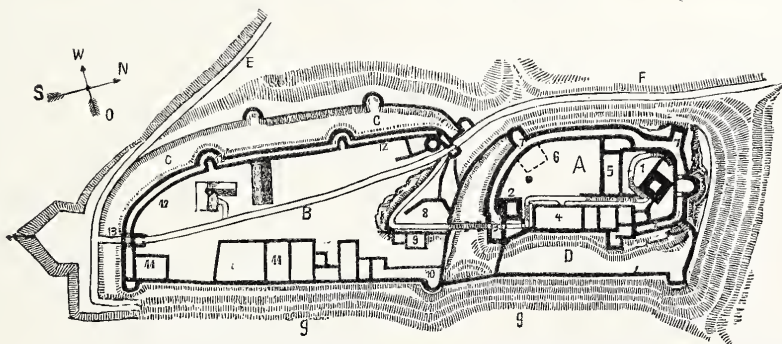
Lageplan (1:1500). A. Obere Burg: 1) Bergfried. 2) Warthurm. 3) Thor- eingang. 4) Ritterwohnung. 5) Kapelle. 6) Schlosshof mit Brunnen. 7) Gedeckter Wehrgang mit Flankierungsthürmen. — B. Untere Burg: 8. Brückenkopf. 9) Wachtgebäude. 10) Thurm. 11) Dienstgebäude, Stallungen, Speicher usw. 12) Gedeckter Wehrgang. 13) Hauptthor. — CC Graben. — D Schlossgarten. — E Weg vom Thal. — F Waldweg. — GG Steiler Abhang.
